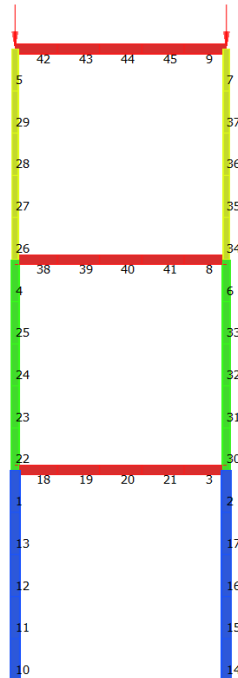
Modello Numerico ad elementi Beam del Telaio - Straus 7
